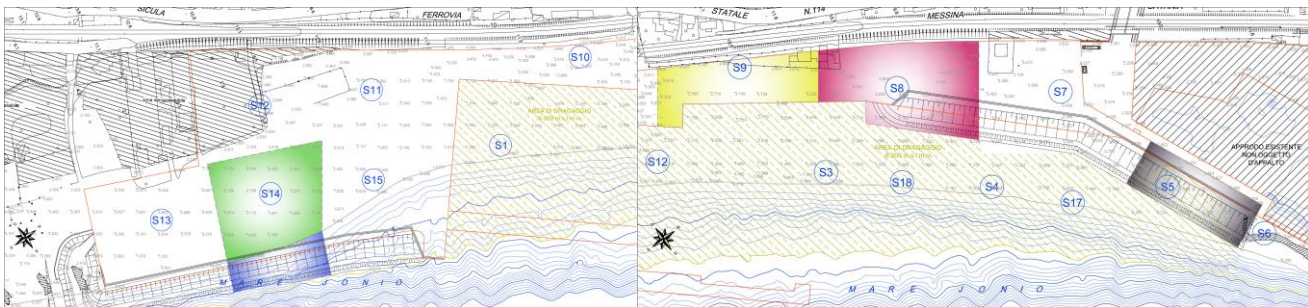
Planimetria interventi di vibroflottazione (elaborato B006E).
